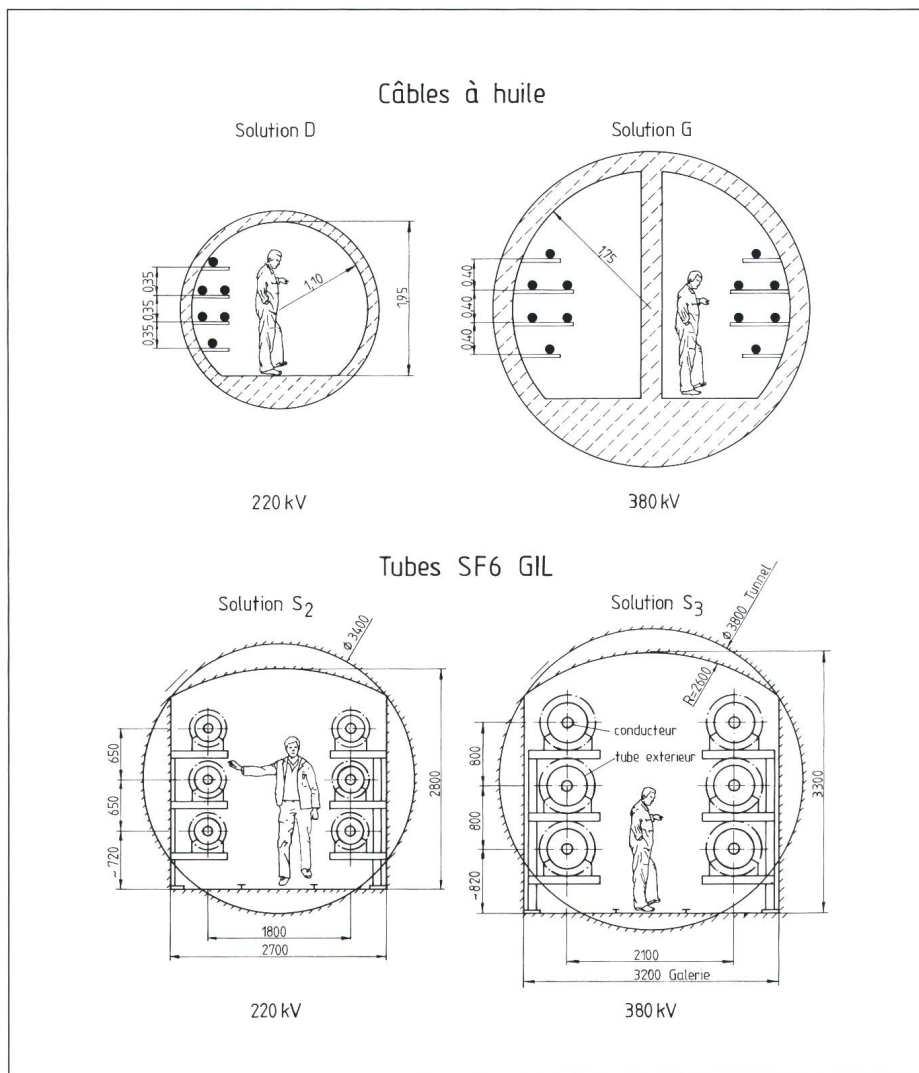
Profil type pour pose en tunnel 220 et 380 kV
